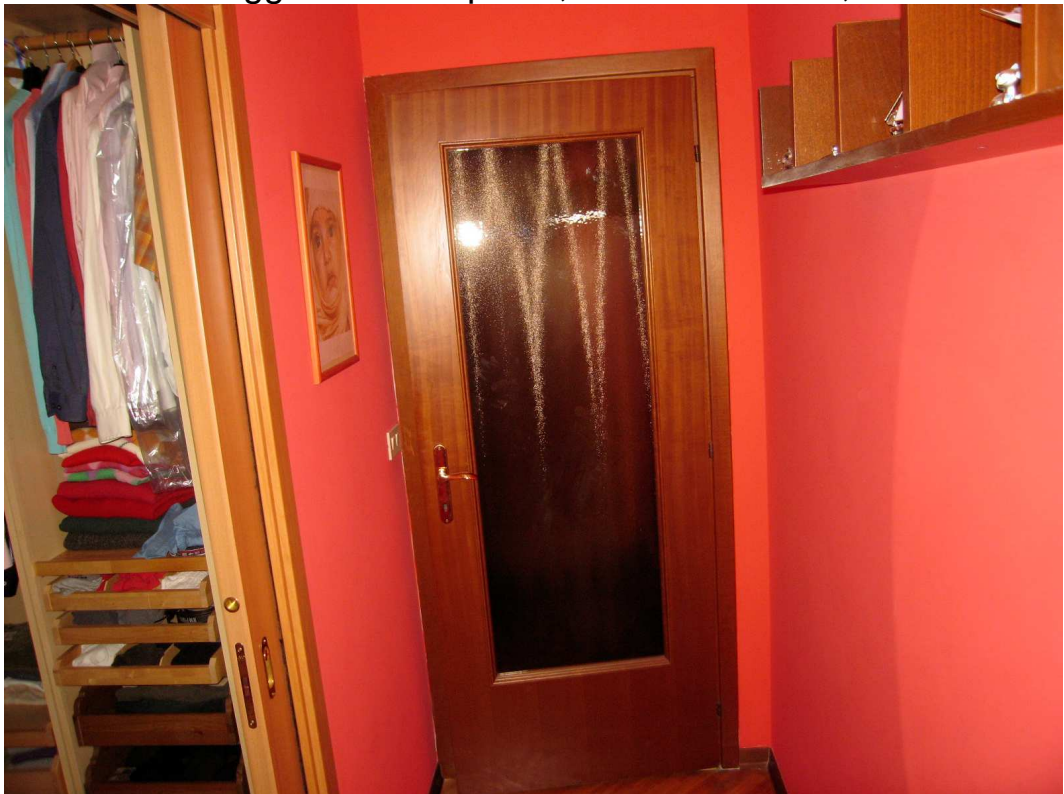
Alloggio al terzo piano, subalterno "10", stanza 1
